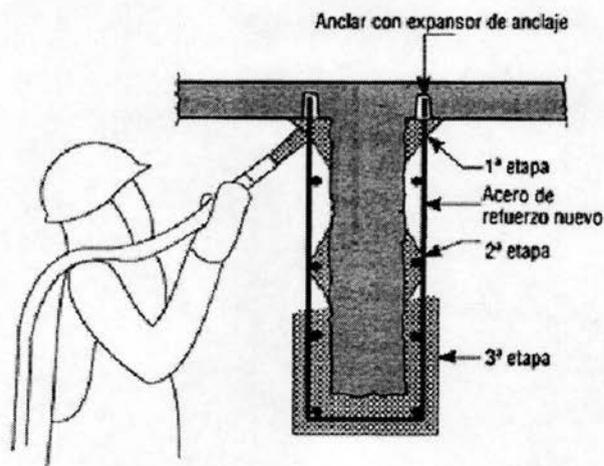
Reparación de vigas. a) Refuerzo - Flexión
